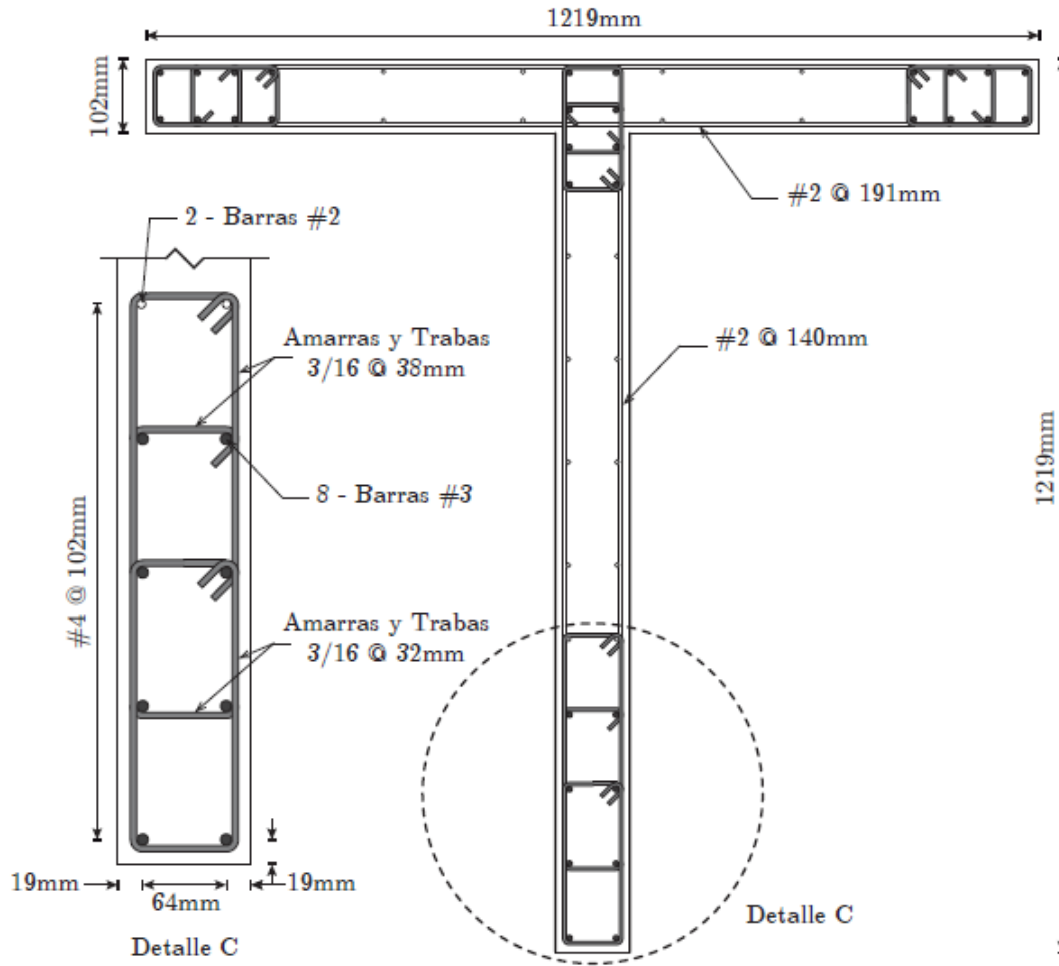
Detalle de la armadura del muro TW2 (Hernández [6]).
